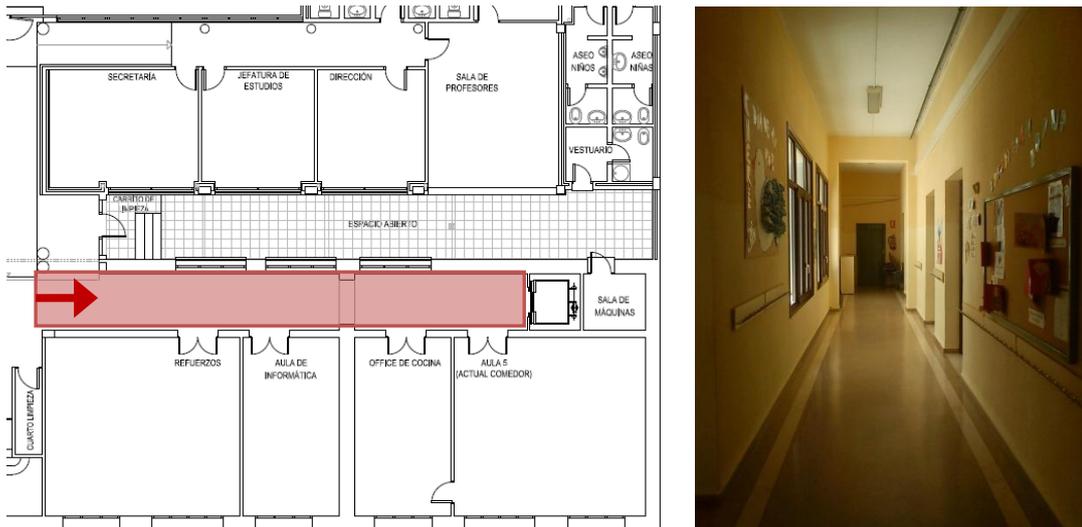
Situación y vista del pasillo Oeste-A de P.B. (foto autor)
